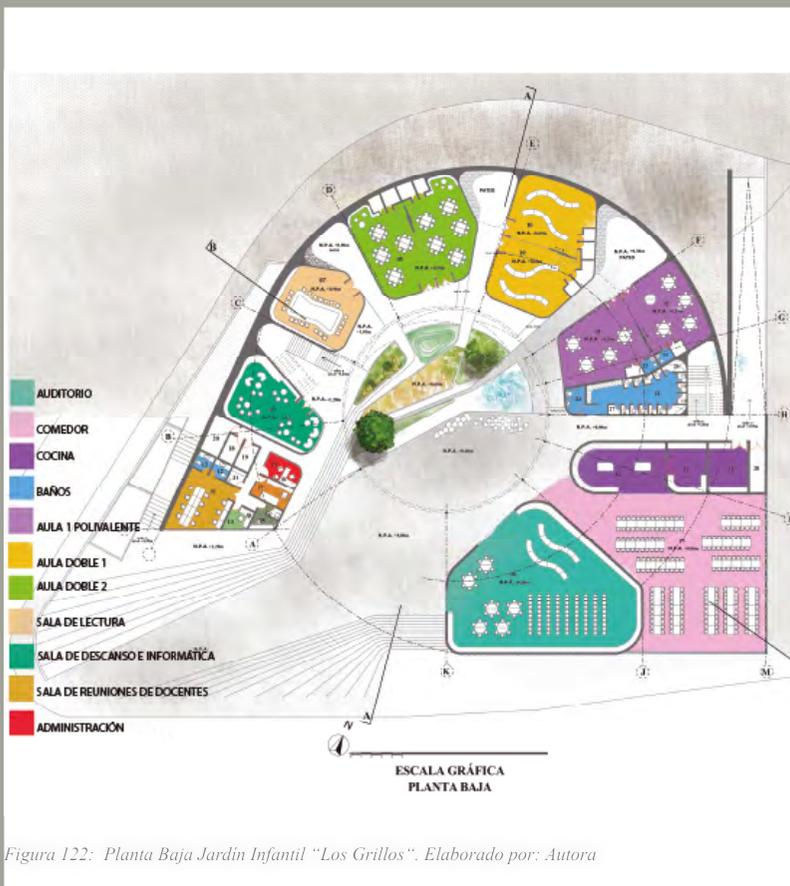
Planta Baja Jardín Infantil “Los Grillos”. Elaborado por: Autora
